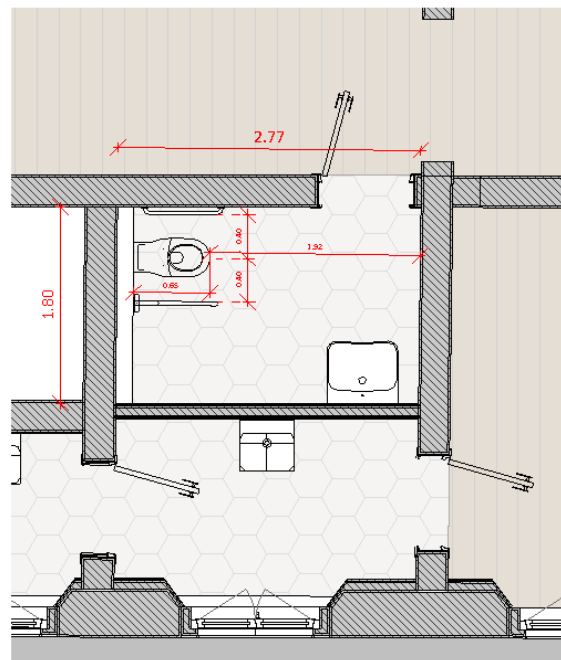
Estratto tavola di progetto – Edificio B bagno piano primo.
